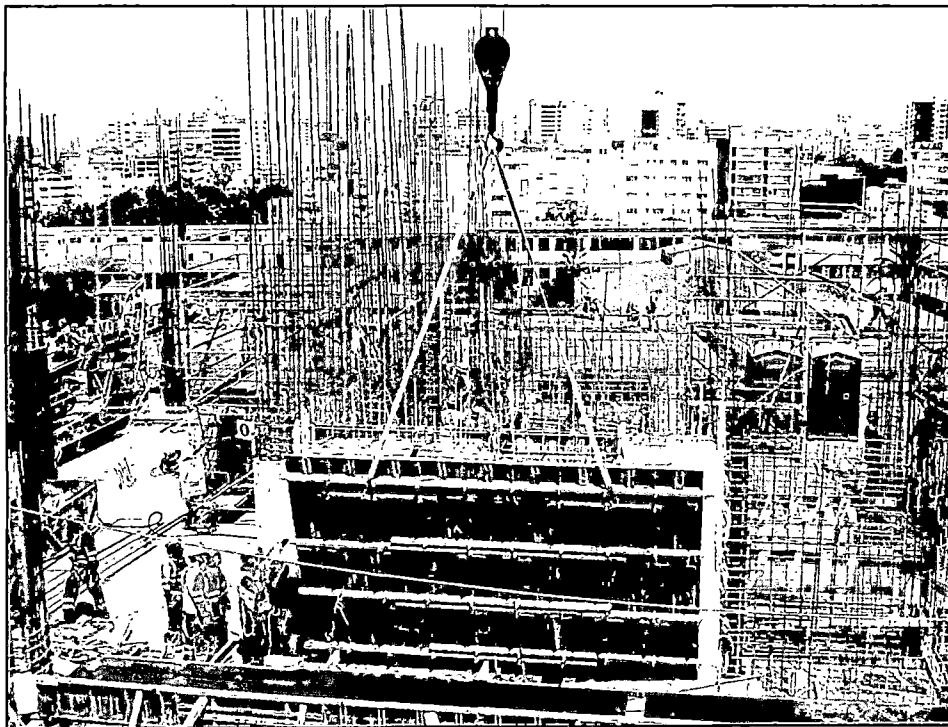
Encofrado de elemento pre armados en Real 8.
